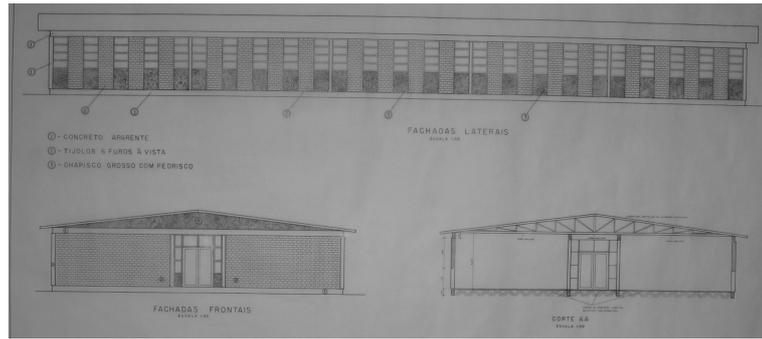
Bloco Didático Padrão (Elevações e Corte) [1973].
